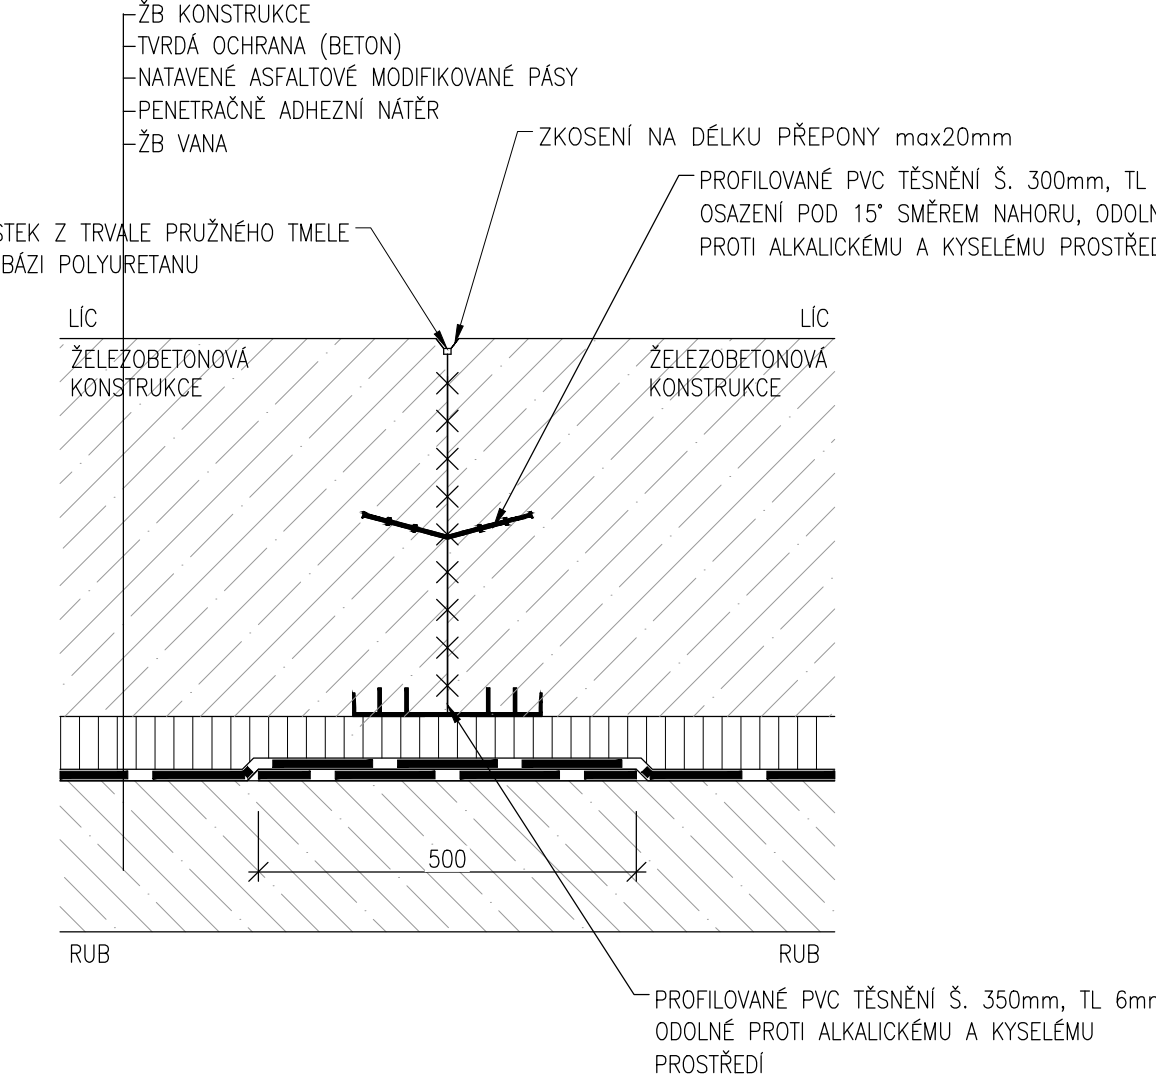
DETAIL ÚPRAVY PRACOVNÍ SPÁRY VE STĚNĚ
